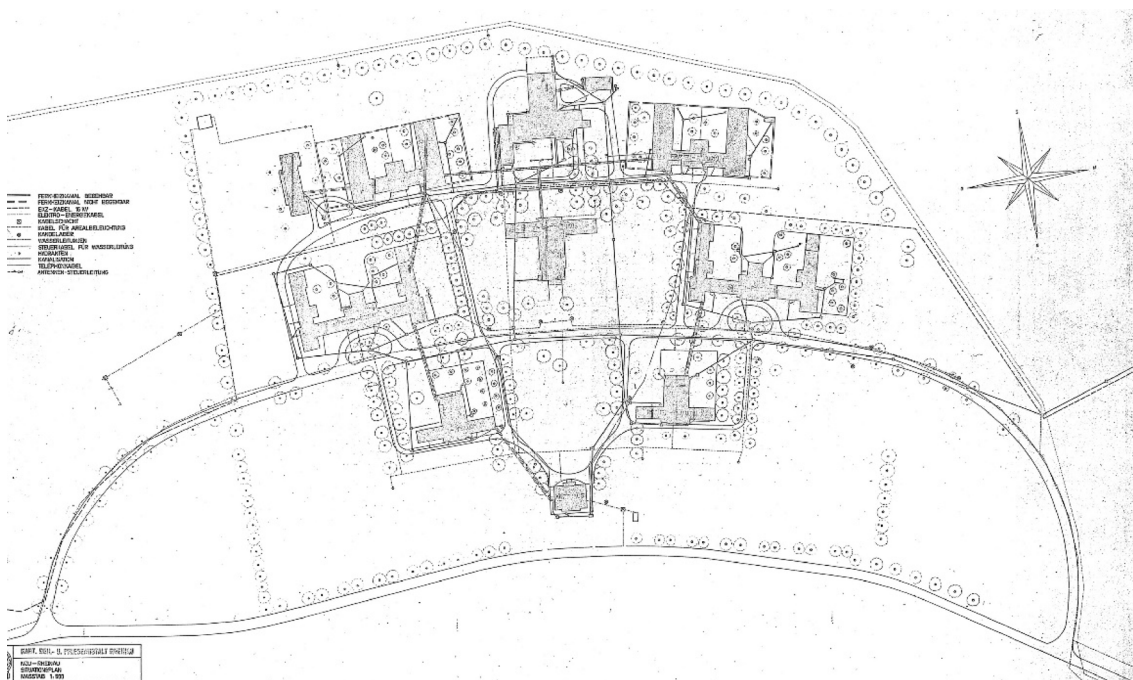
Die Bauten der ersten beiden Bauetappen von Neu-Rheinau mitsamt Casino (Leitungsplan); Hochbauamt des Kantons Zürich, 1963; Plan nach Süden ausgerichtet
